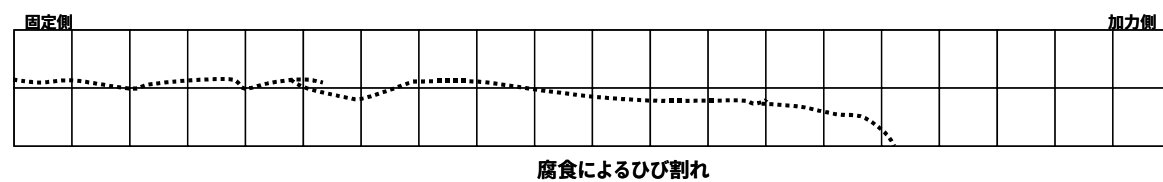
断面減少率2.7%試験体のひび割れ発生状況
